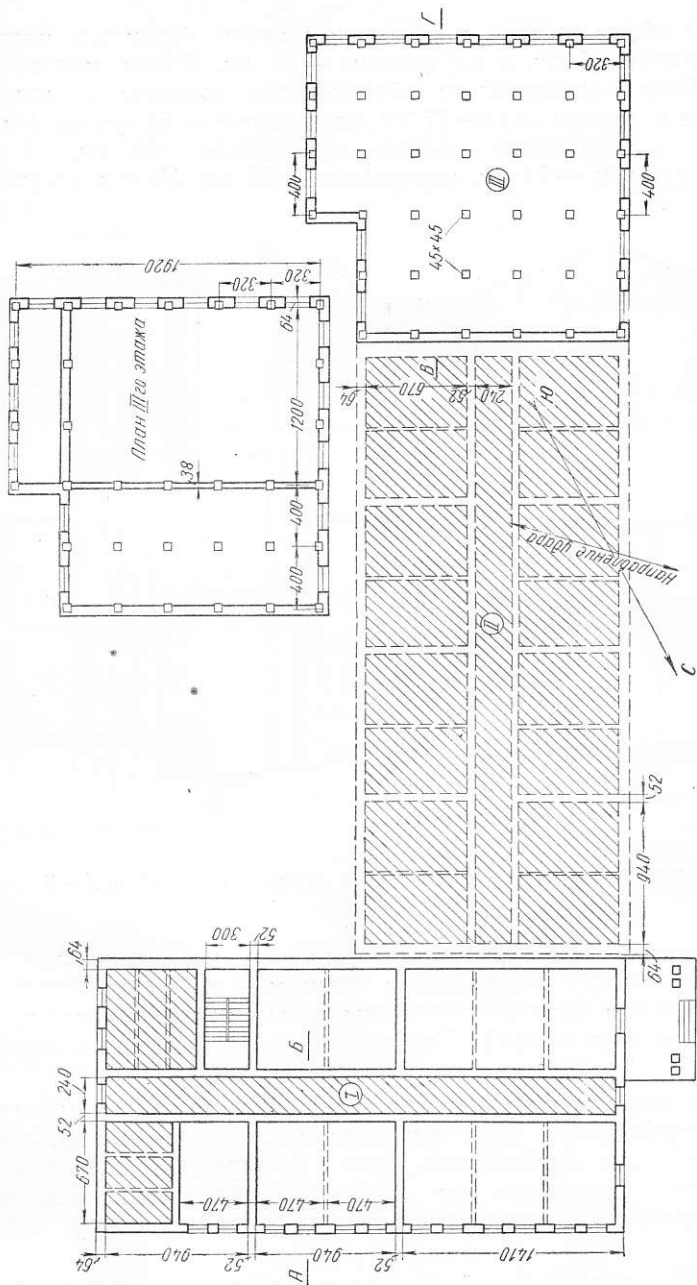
Схема плана 2-го этажа Дома техники железнодорожников (пунктиром показаны разрушенные стены и железобетонные балки; железобетонные перекрытия заштрихованы)
